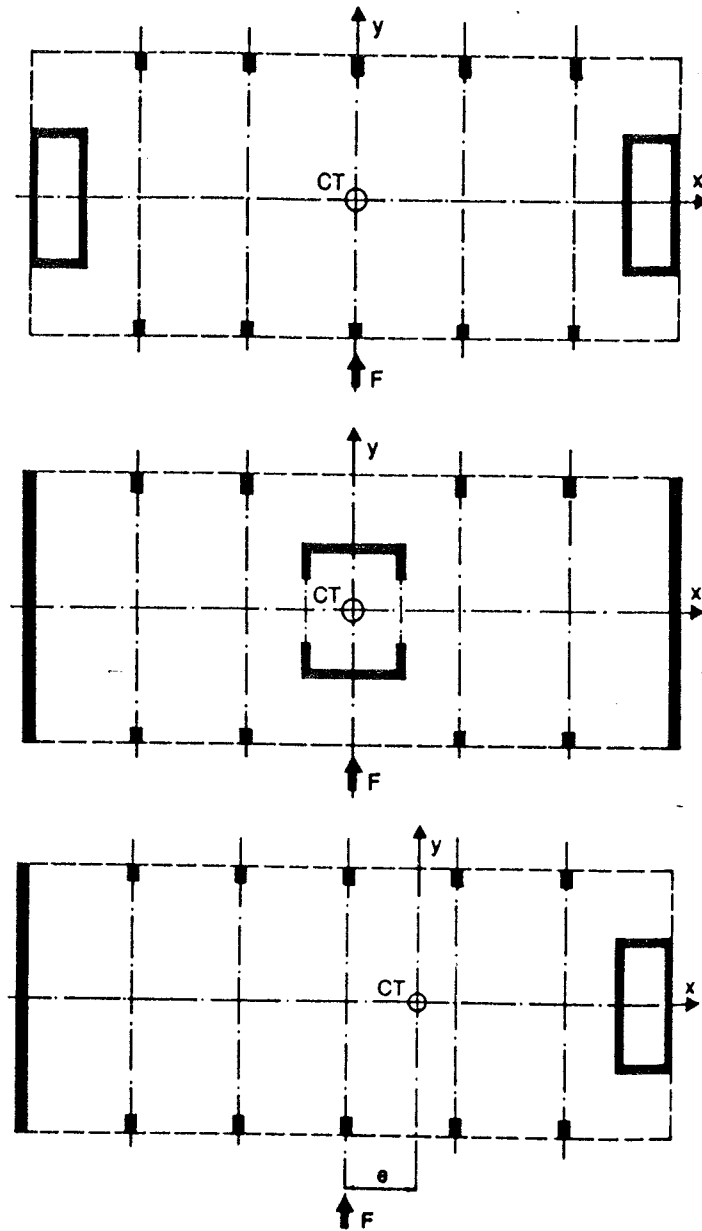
Outros arranjos possíveis (Fonte: ABCI [1]).
